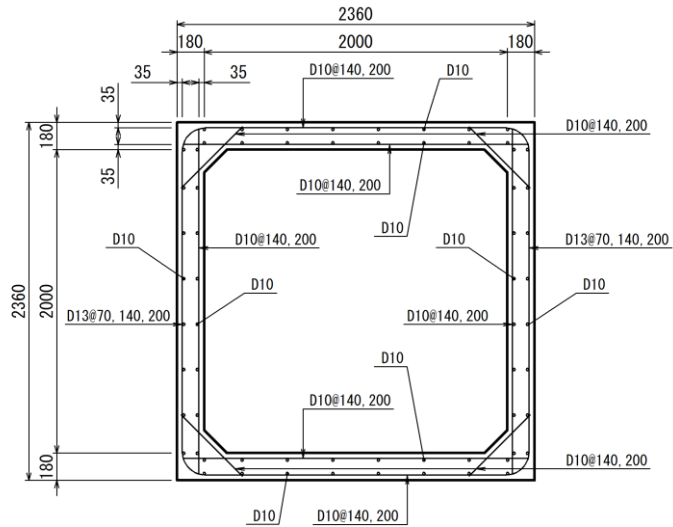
(2) 屋外排水路（防波壁横断部）の概略断面図
